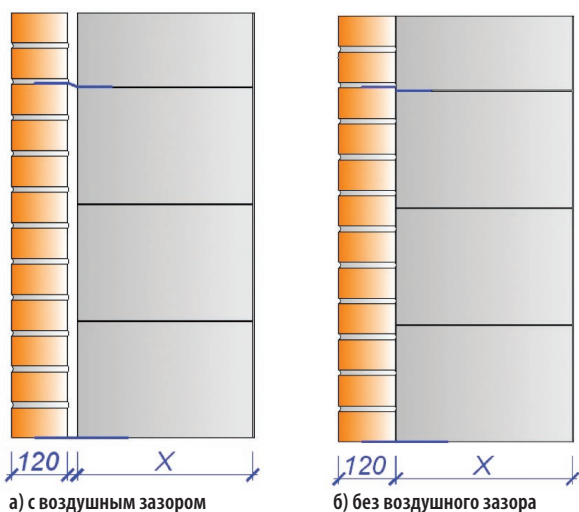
Стеновые заполнения из газобетона с наружной облицовкой кирпичом
